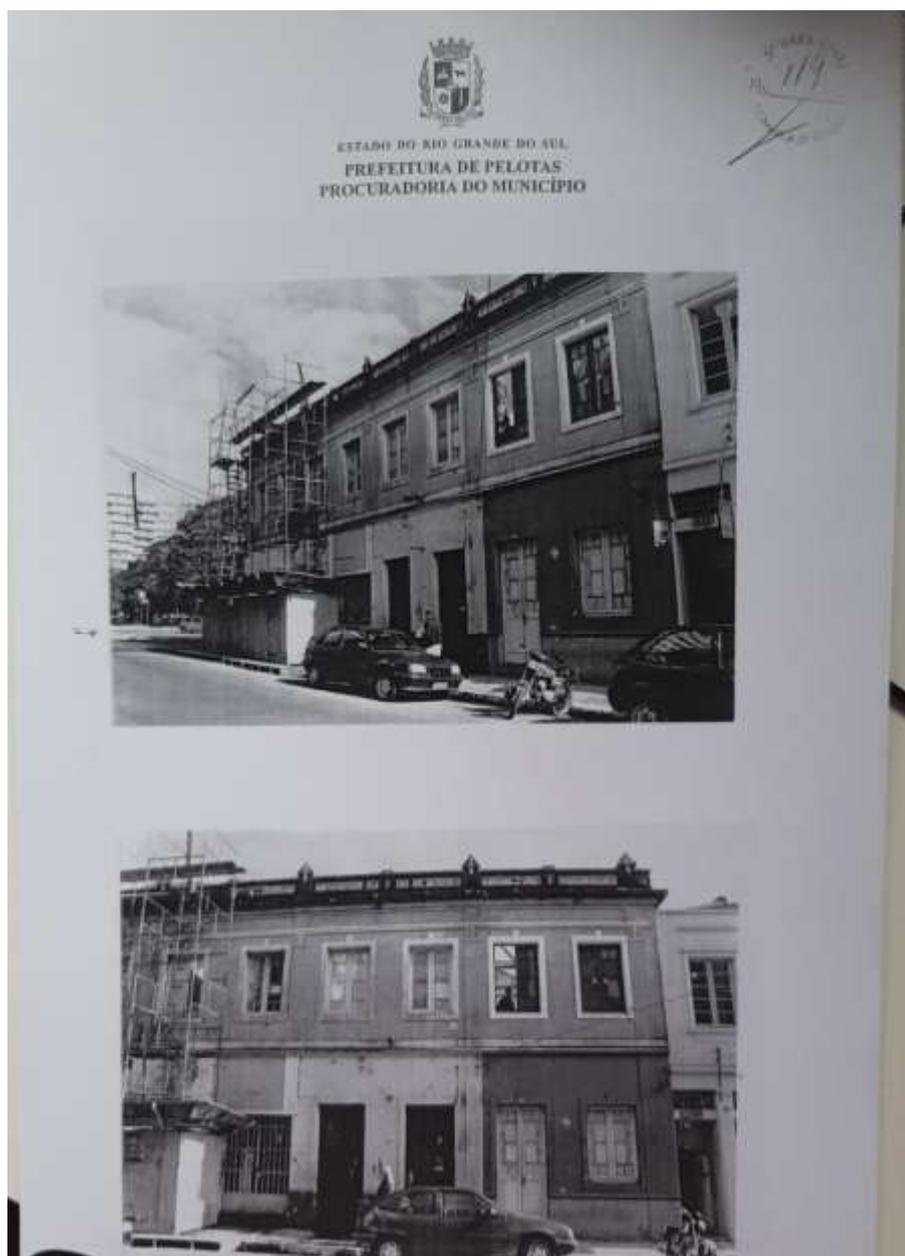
Fachada da Casa da Banha, com a obra de conservação do telhado em andamento, demonstrando, também, que o imóvel estava desocupado.
